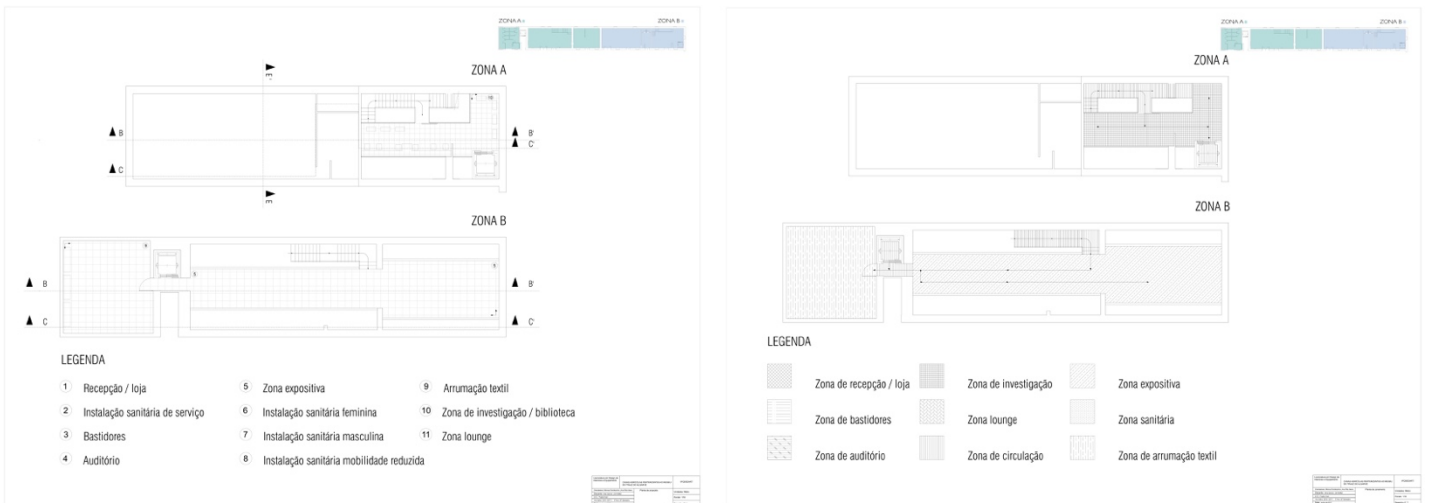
Planta de proposta do piso 1 e planta de zonamentos do piso 1 respetivamente da esquerda para a direita. Elaborado por: Vera Sancho
